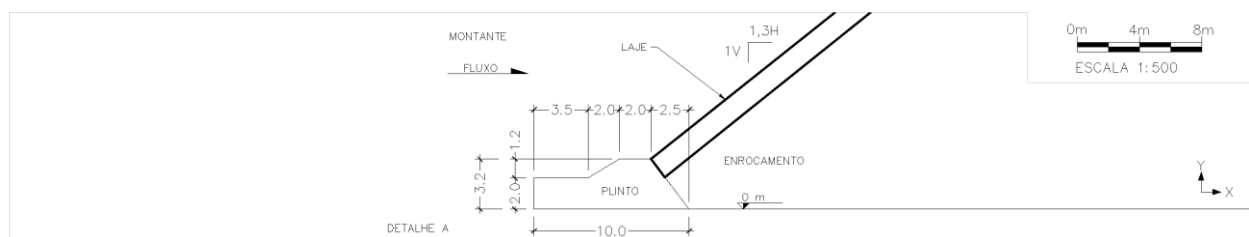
Detalhe A, com as dimensões do plinto.
